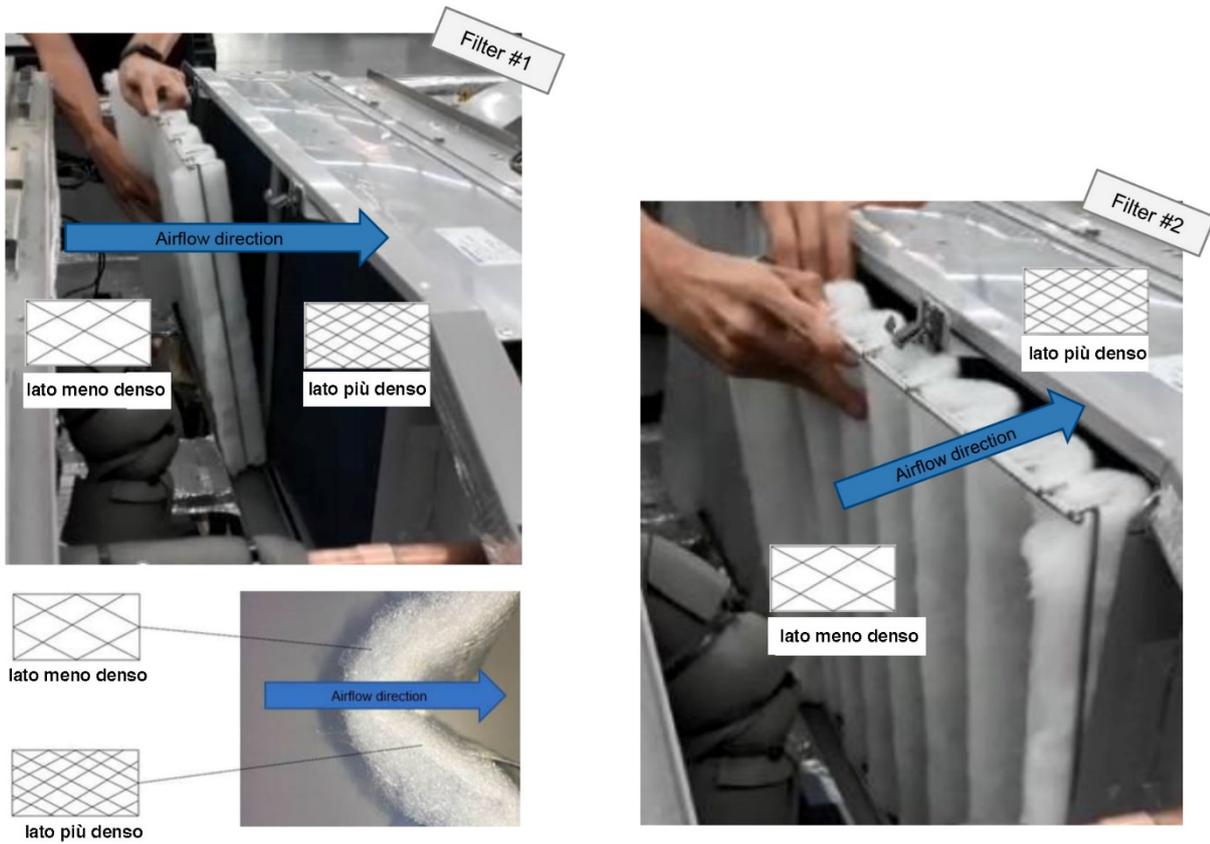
Vista del corretto montaggio e direzione dei filtri aria
